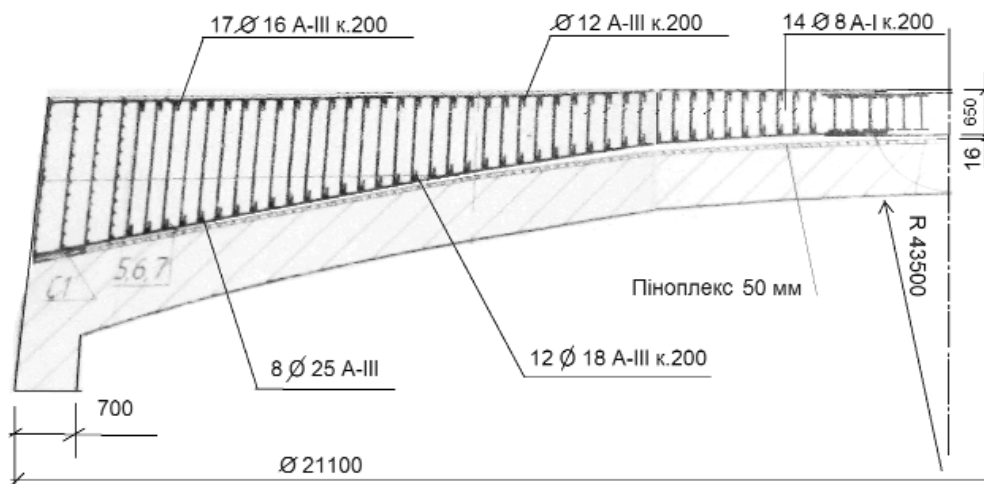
Схема армування фундаментної плити будівлі Музею історії Києва
